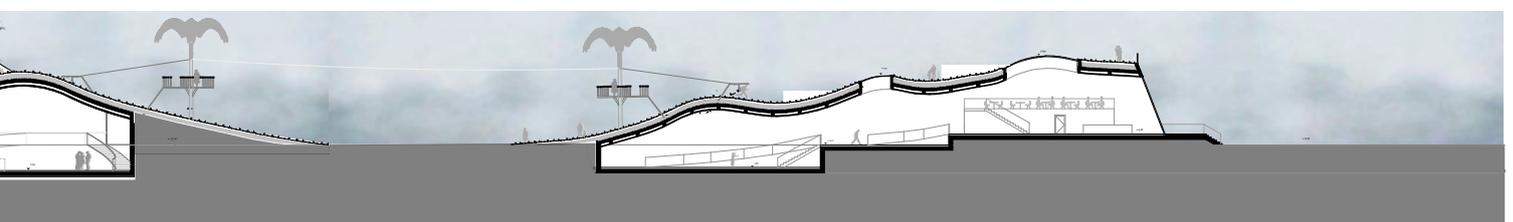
Schnitt durch die eingebetten Grundrisse
